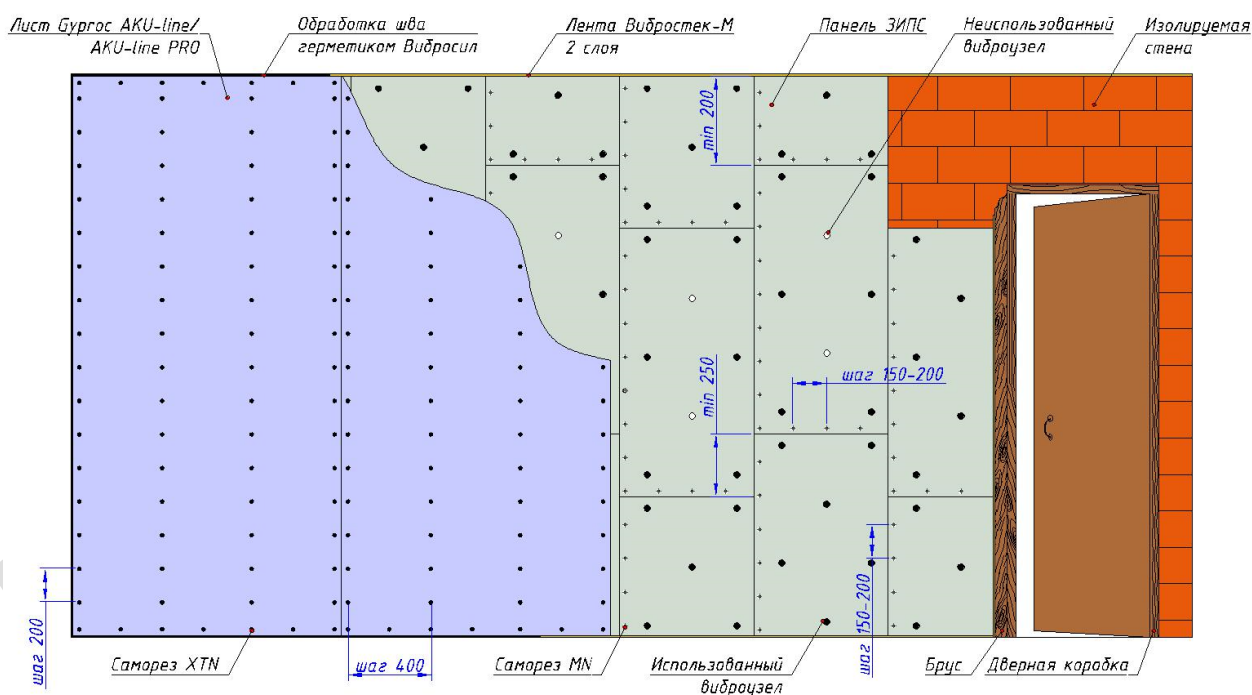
Схема монтажа бескаркасной системы ЗИПС.
